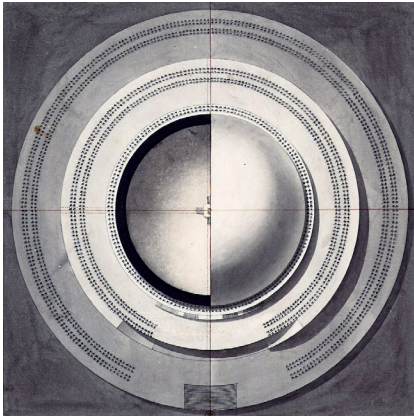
e 6. Planta e corte do Cenotáfio de Isaac Newton. Projecto da autoria de Boullée.
